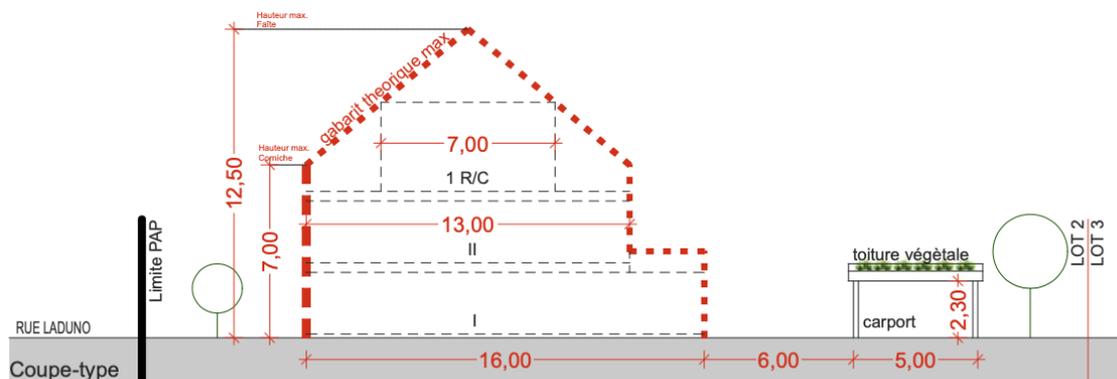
Coupe dressée par Architecte Speicher Marc, Septembre 2023
